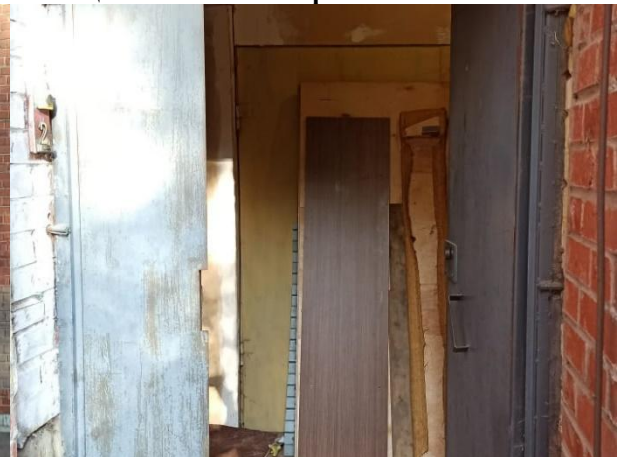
Общий вход с нежилыми помещениями со двора (дверной проем закрыт)
